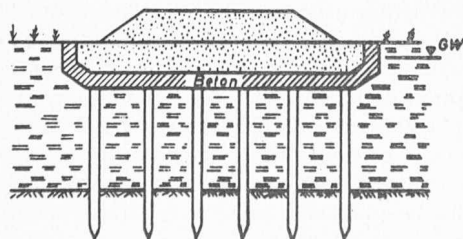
Chaussée en tourbière sur pieux en béton armé.
